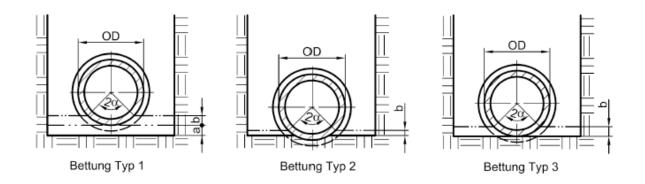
Rohrbettungen nach DIN EN 1610, Ziffer 7.2
